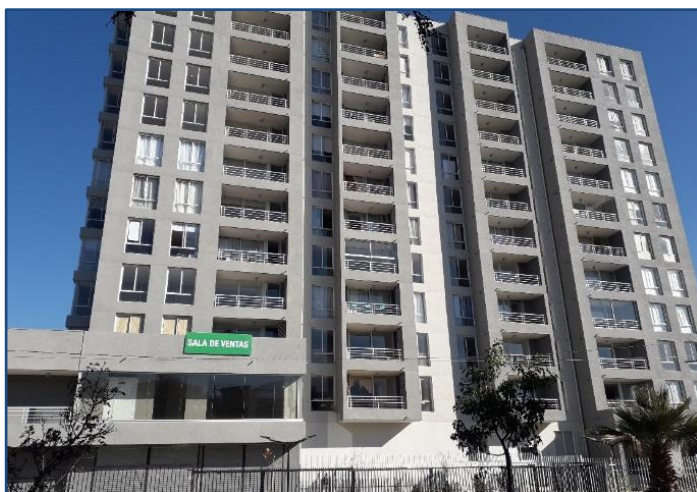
Edificio Altum ubicado en Avenida Concha y Toro
